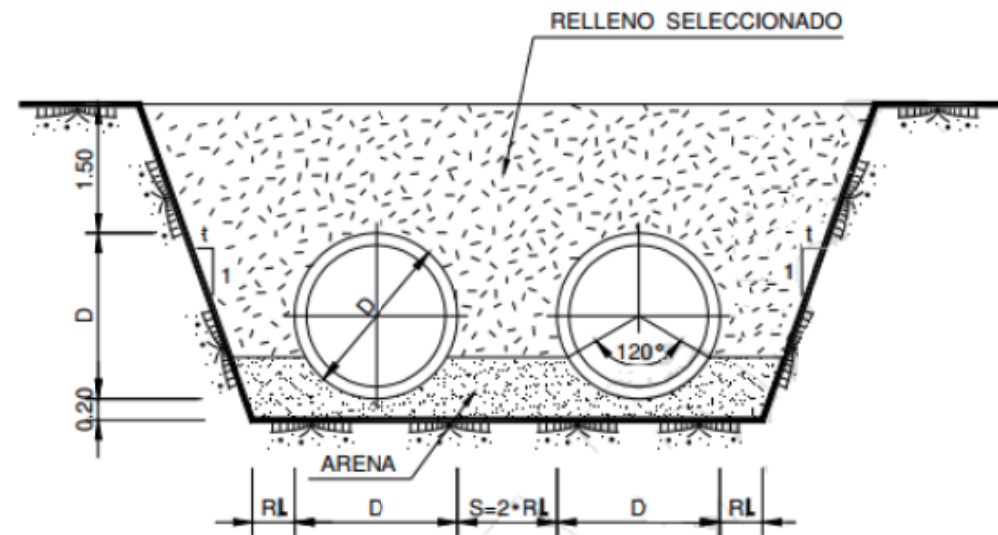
Sección Tipo Perfil Transversal Zanja y Tubería
